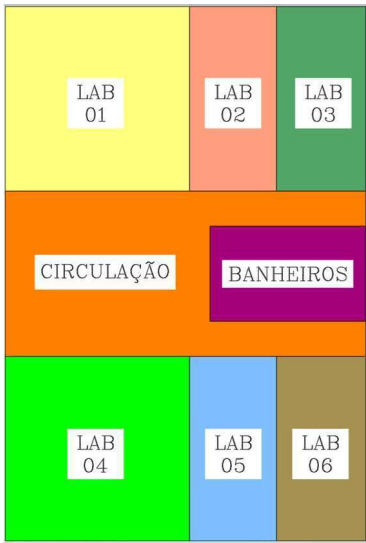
Planta baixa com as Zonas Térmicas do Pavimento Térreo.
